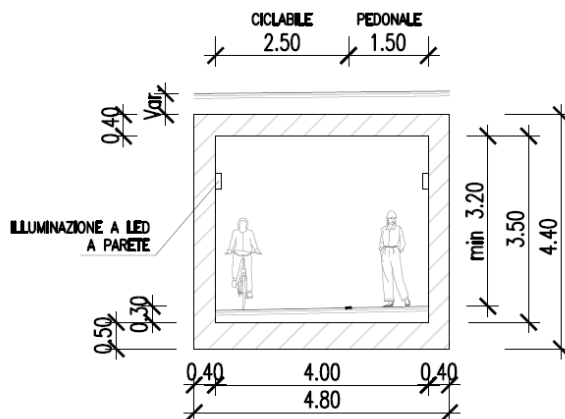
estratto sezione tipologica sottopasso ciclopedonale.
